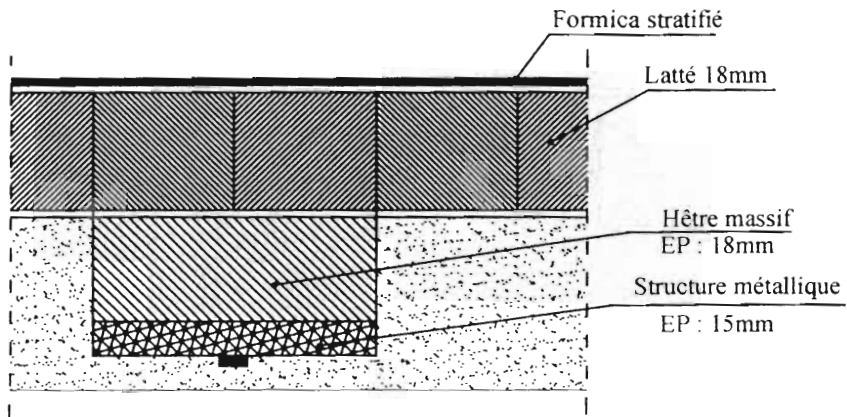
DETAIL DE LA PLANCHE DE TRAVAIL OU TOP
